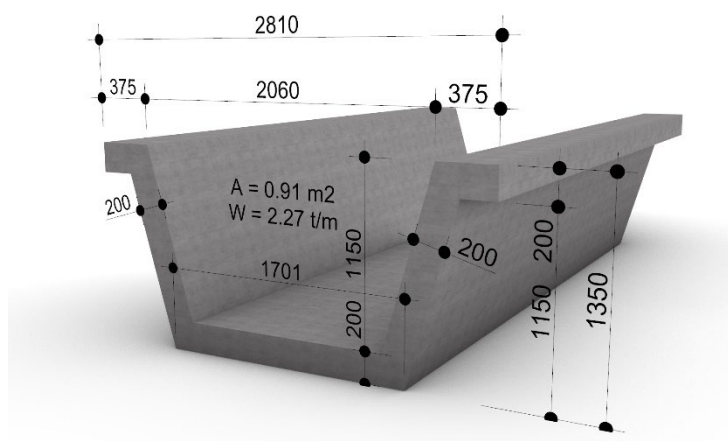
Design corrente della trave del vigneto: Trave in Calcestruzzo Armato (CA) precompressa del vigneto
